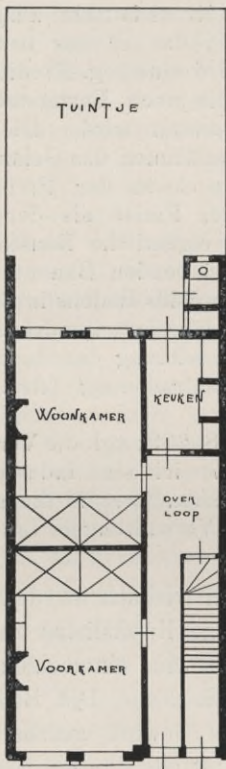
Zweiwohnungshaus, Reihenbau; Unternehmerbau Groningen. Grundriß der Erdgeschoßwohnung.
